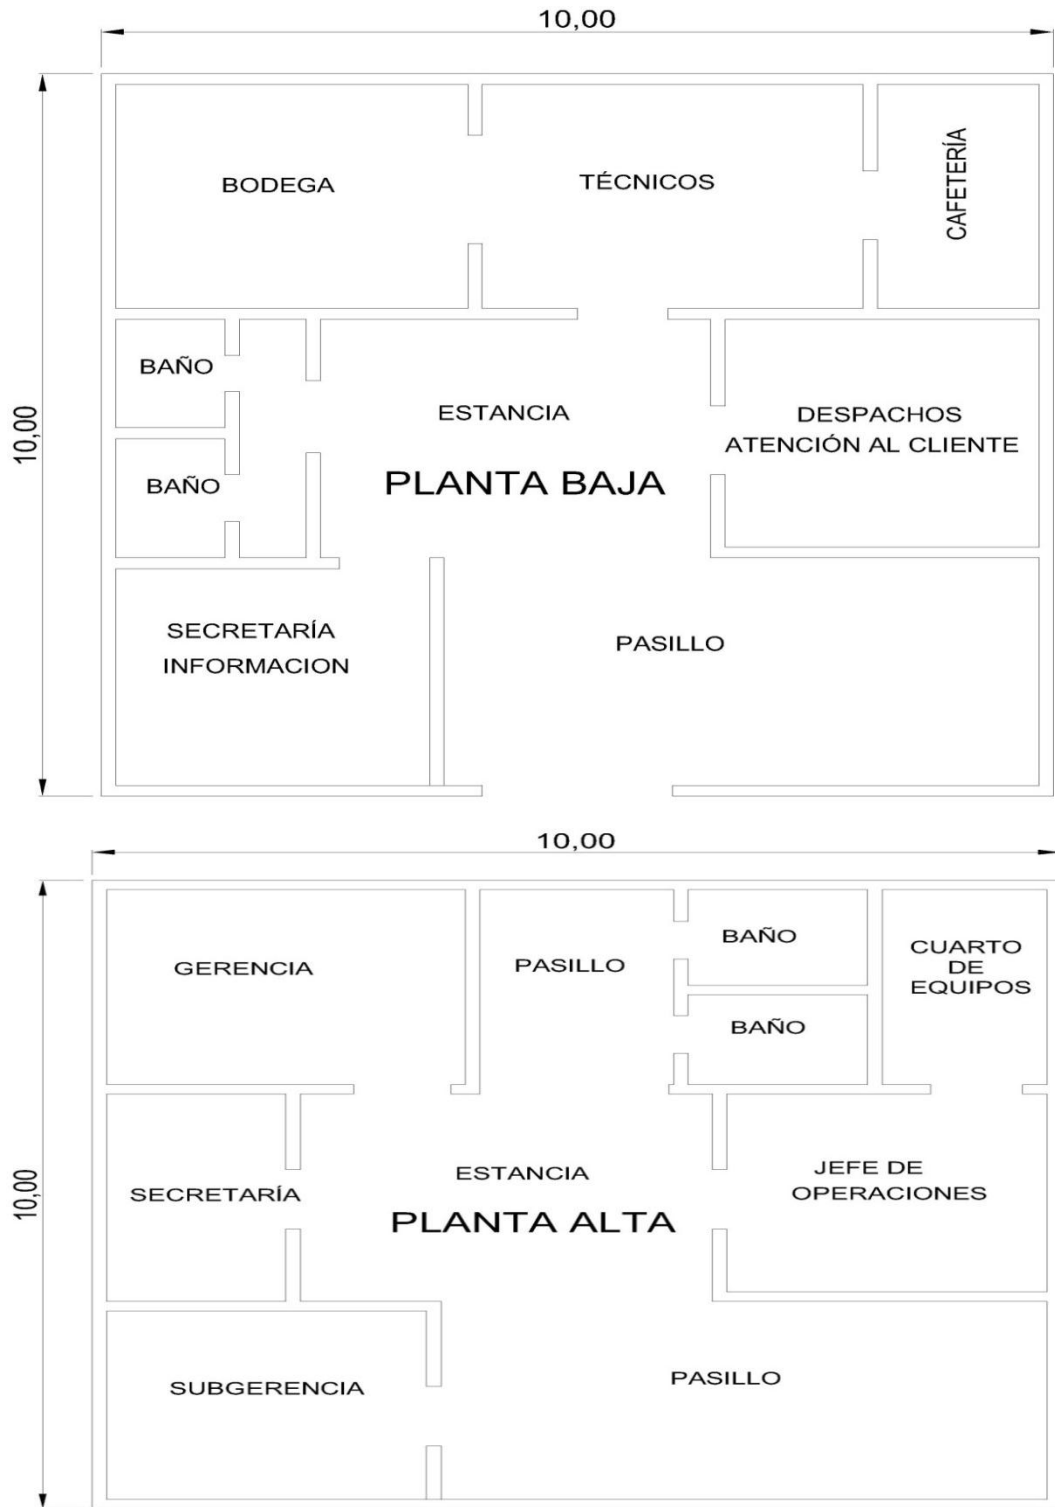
Etiquetas y Planos planta alta y planta baja AutoCAD
